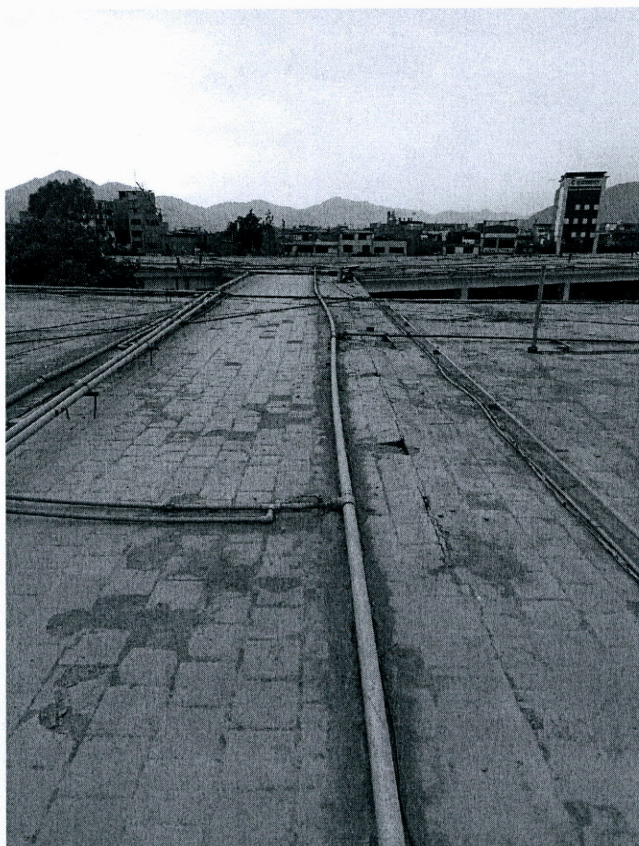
Azotea: Se observa la corrosión de las válvulas de sectorización y tubería de PVC no cuenta con soportería y no tiene un orden de instalación.
